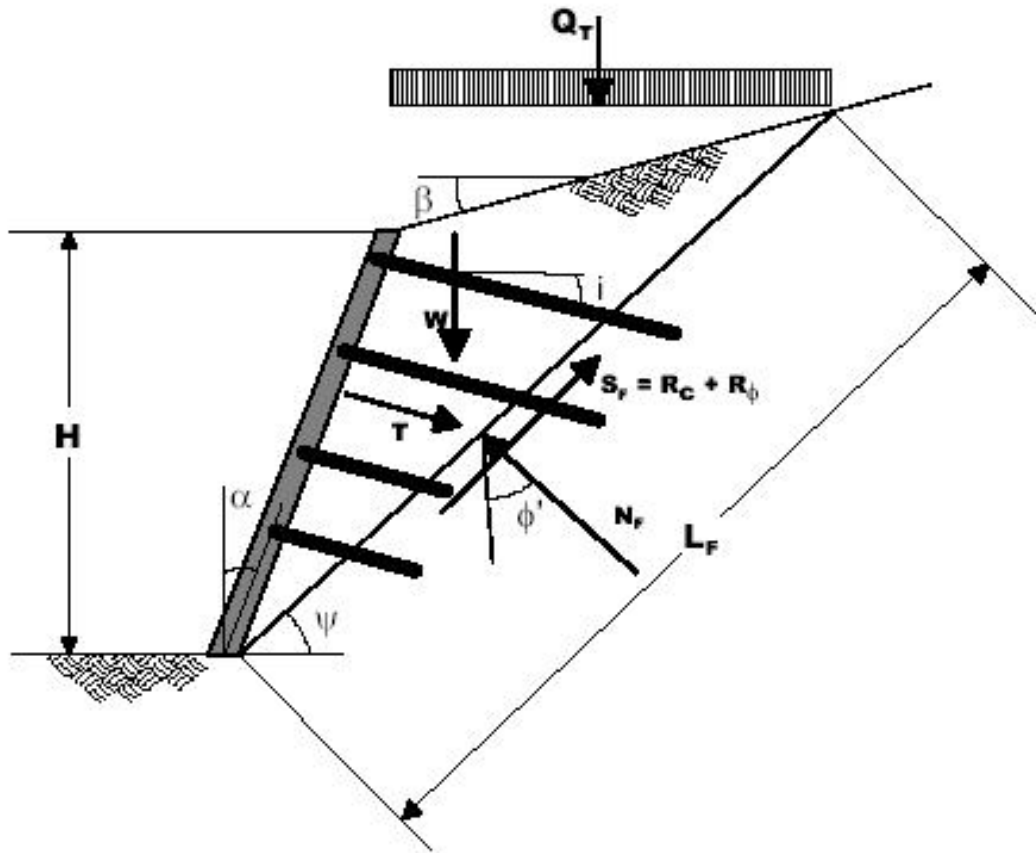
Análisis de estabilidad global de muro de soil nailing.
